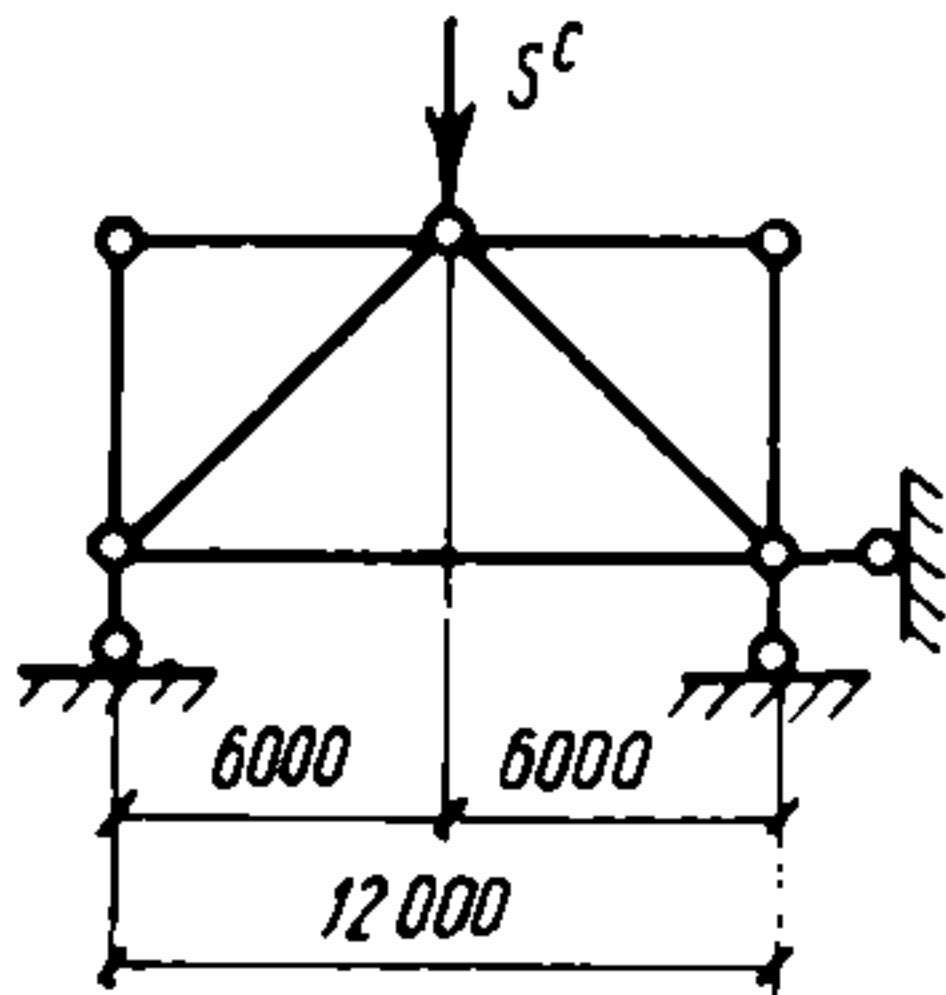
Расчетная схема продольной связи по нижним поясам стропильных ферм при учете сейсмической нагрузки от веса стен
